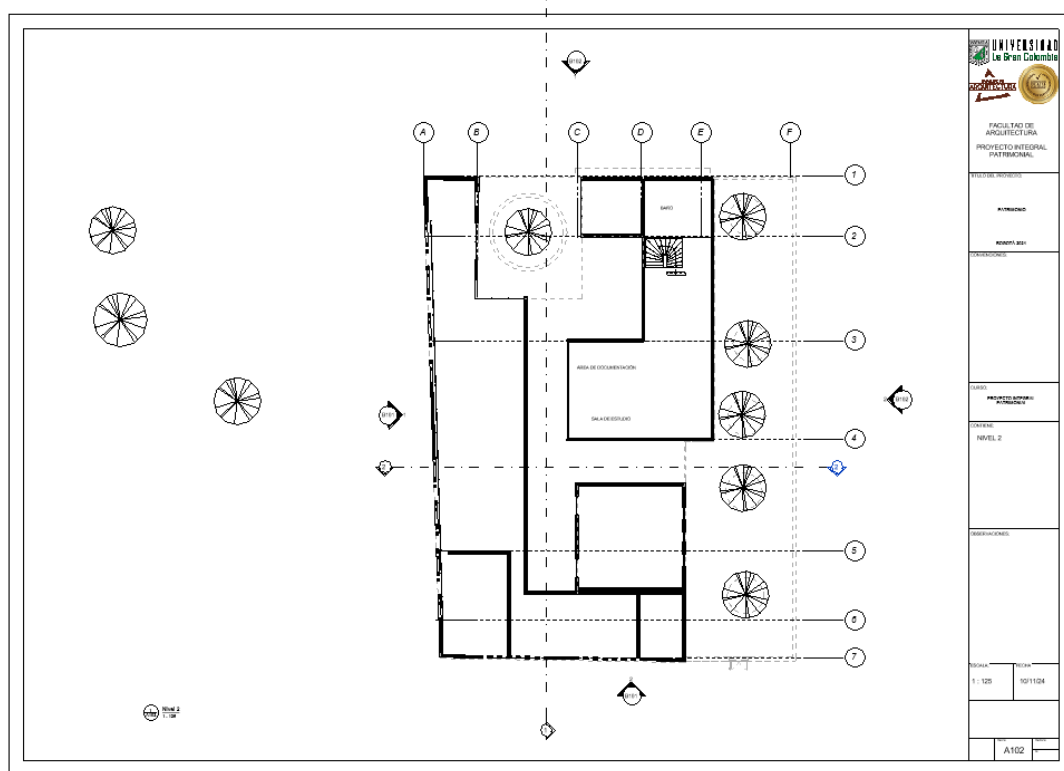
Planimetría y documentación con rótulo. Elaboración propia.
